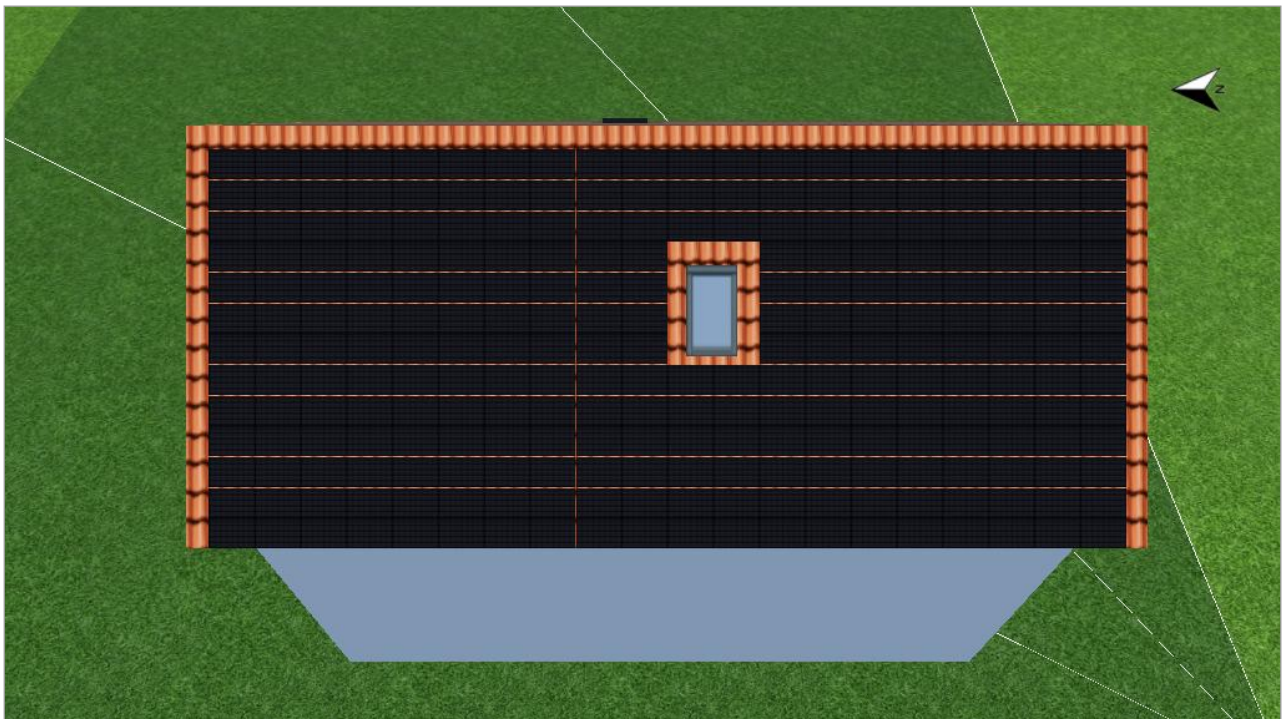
Modulfläche - Gebäude 01-Dachfläche West
